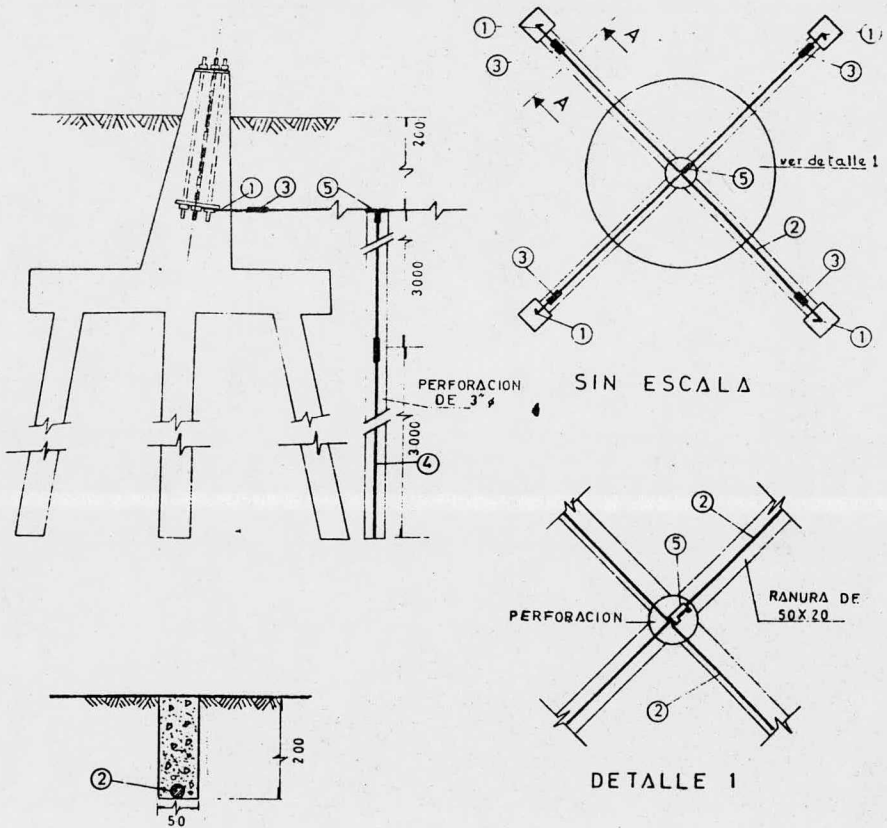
CONEXION A TIERRA PARA TORRES DE 400 kV CON CIMENTACION DE PILOTES HINCADOS. 1.- GRAPA CROSBY ; 2.- CABLE DE COBRE ; 3.- CONECTOR PARA CABLE DE CU BURNDY ; 4.- ELECTRODO DE VARILLA COPPERWELD ; 5.- CONECTOR T PARA CABLE DE COBRE BURNDY.
